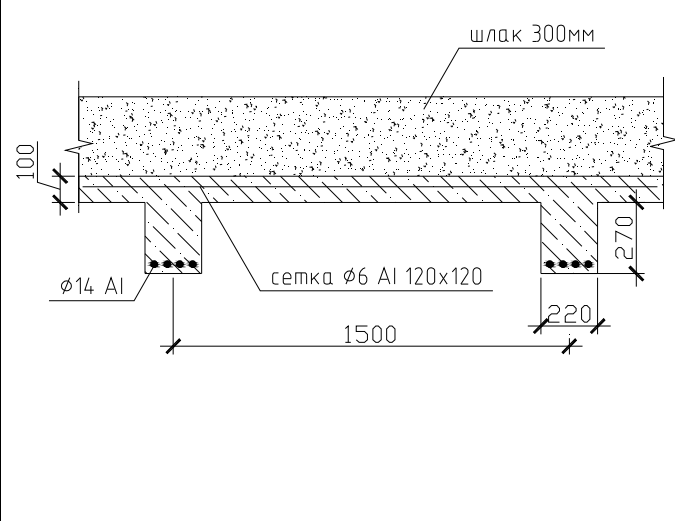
Второстепенная балка ж/б перекрытия над пятым этажом в осях «8–9/А–В»
